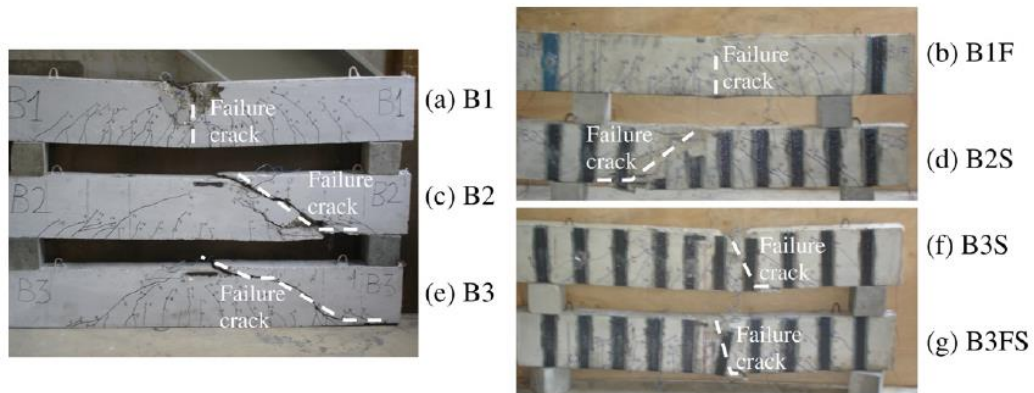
Patrones de fisuras de las vigas probadas a la falla.
